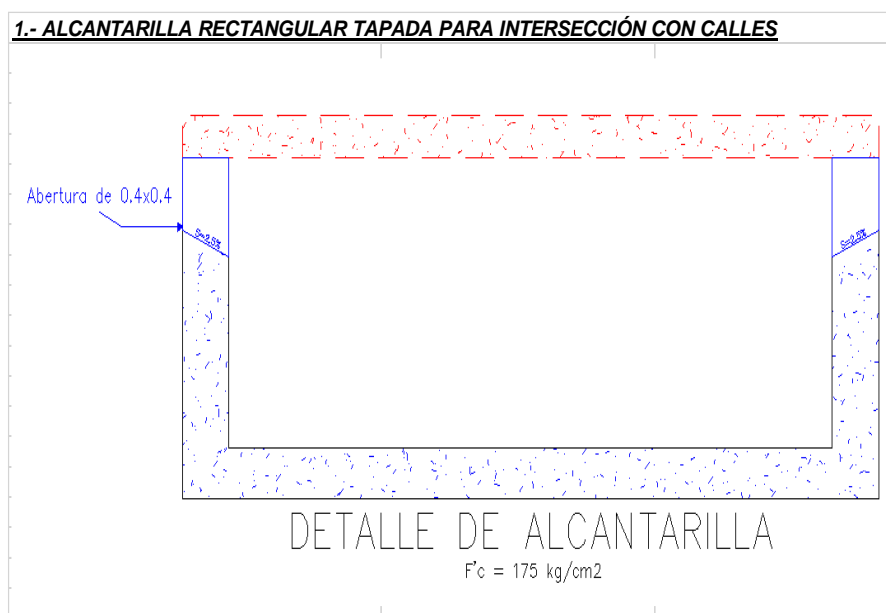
Detalle de alcantarilla con tapa para intersección de calles. Fuente: Elaboración propia.
